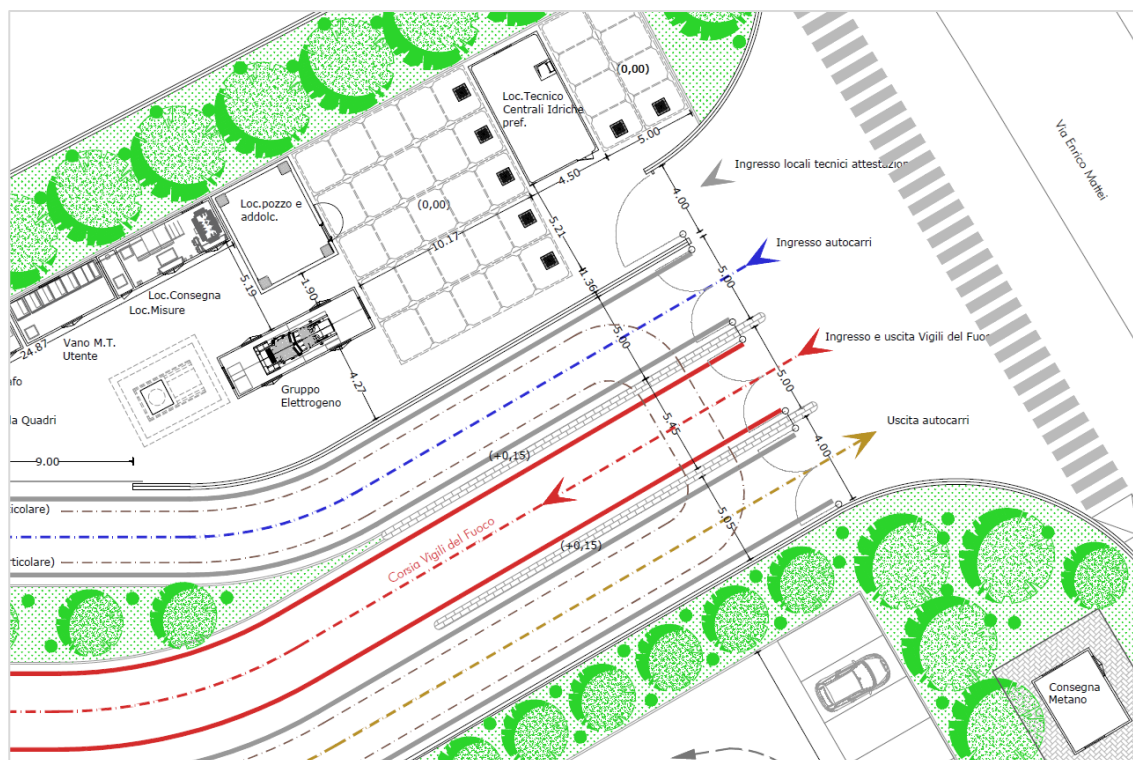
Stralcio dalla planimetria generale – Accessi all'impianto e all'area tecnica
